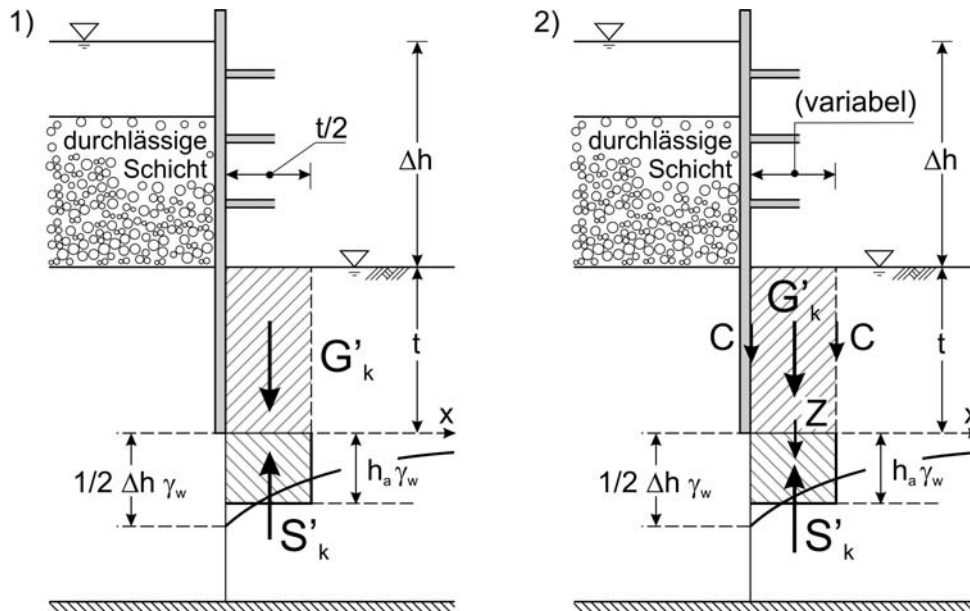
Berechnungsansätze für einen hydraulischen Grundbruch an einer umströmten Baugrubenwand: 1) für nichtbindigen Baugrund nach Terzaghi & Peck (1961), 2) für bindigen Baugrund nach Davidenkoff (1964)
